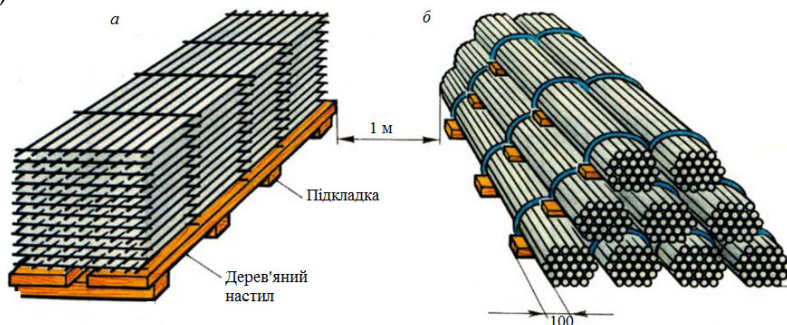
Схема складування арматурних сіток (*а*); металевих труб (*б*),
